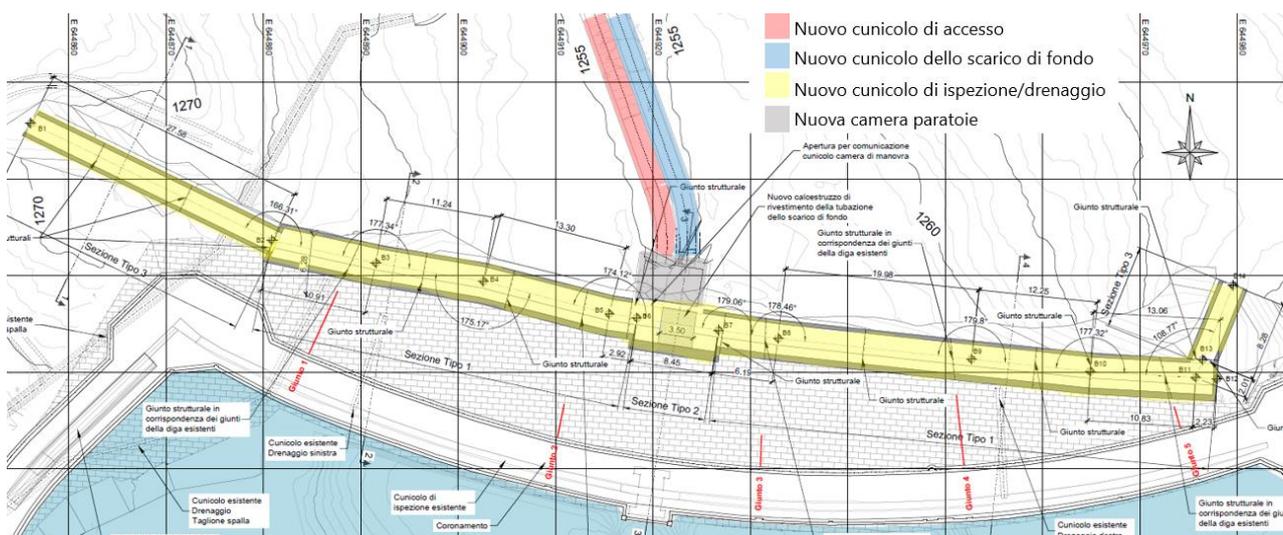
nuovo cunicolo di ispezione e drenaggio, planimetria
